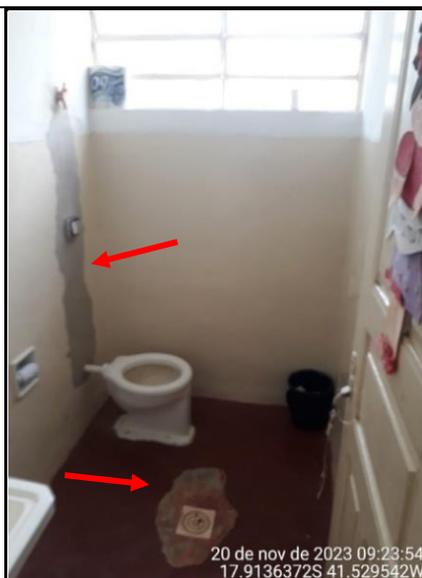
Detalhes de bacia sanitária sem assento e remendos no piso e parede
